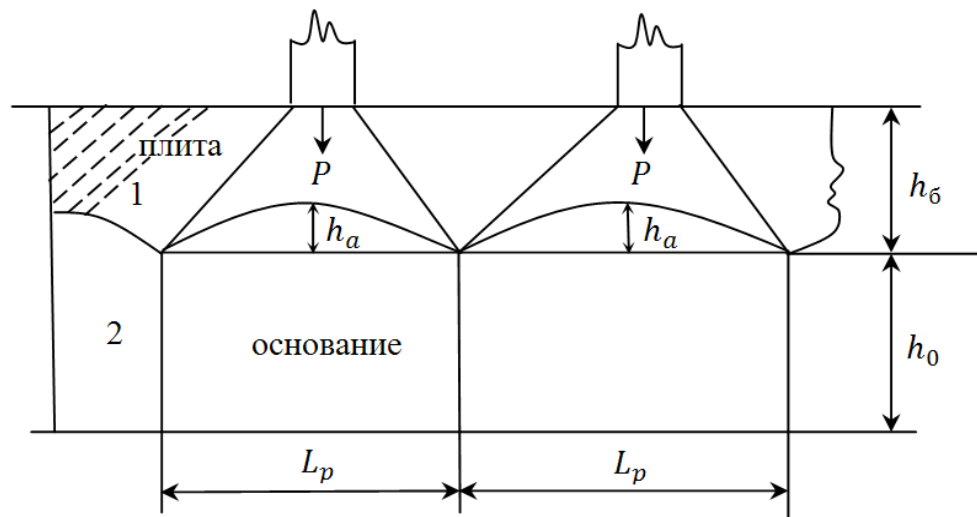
Конструкция бетонного покрытия с арочной опорной поверхностью, $h_a = \frac{1}{3}h_b$, h_b - толщина бетонного покрытия, P – колесная нагрузка на покрытие; 1 - бетонное покрытие; 2 - песчаное основание покрытия.
